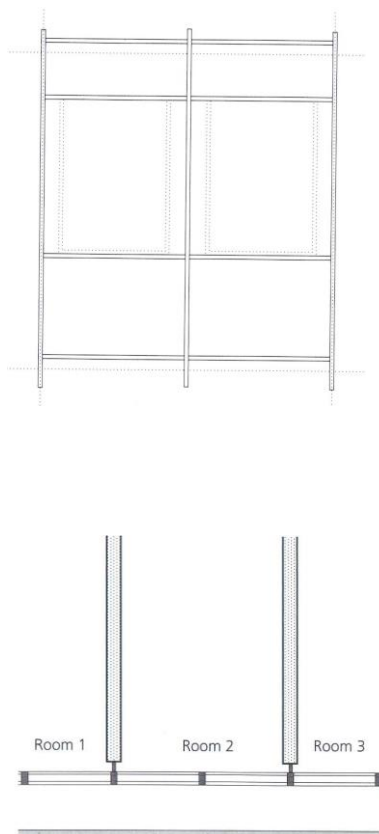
7 Alzado frontal y planta sistema Multistorey Facade (A2)
